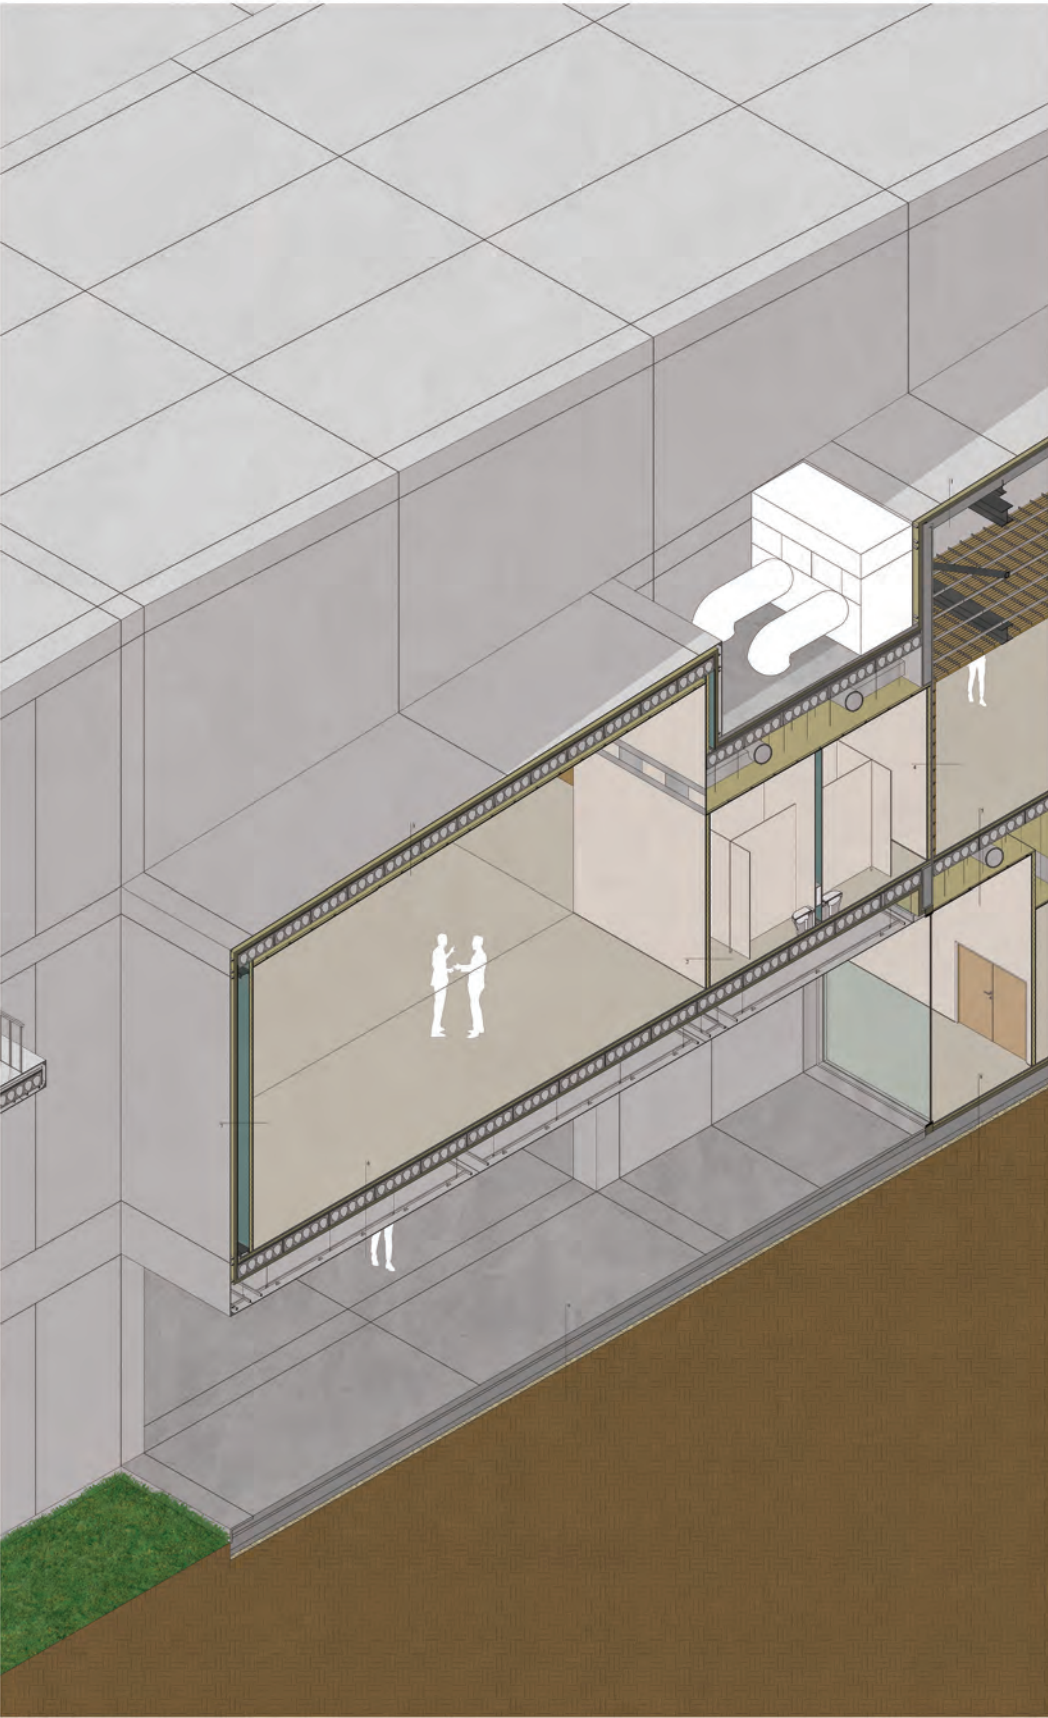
Apoios da placagem exterior da fachada sobre a estrutura do edifício.
